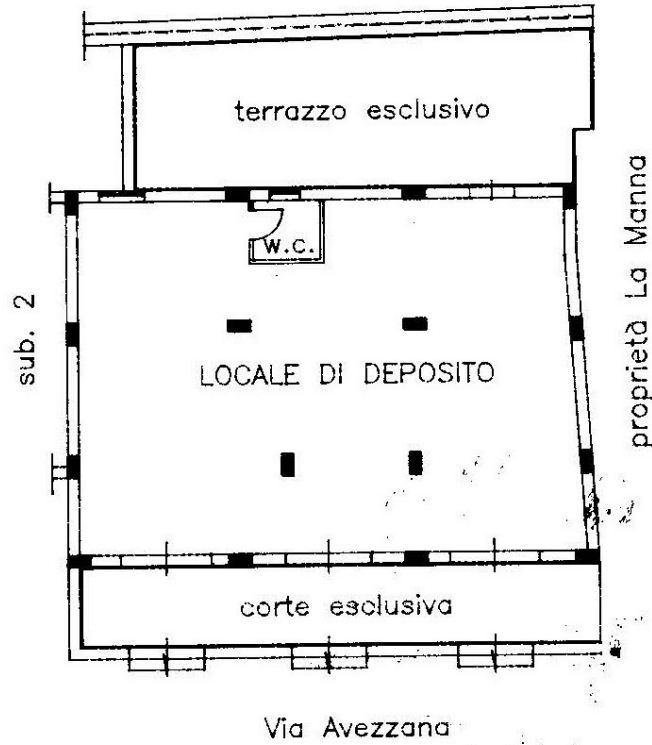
P.lla 5112 Sub 3 – Planimetria Catastale al 22/02/1999
